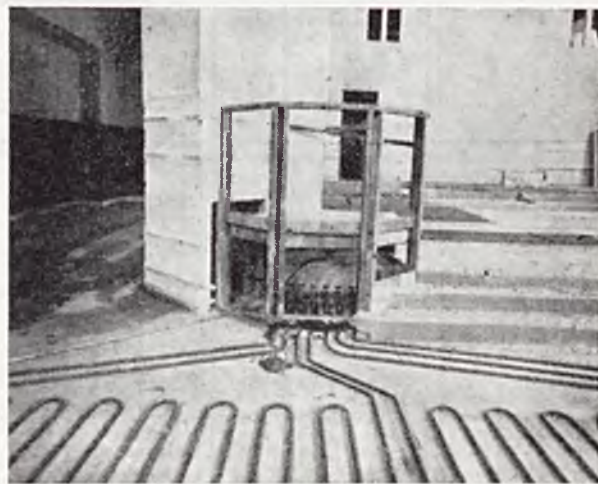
Widok całości instalacji. W głębi na prawo — pokrywanie rur betonem; beton powinien być — o ile można — jak najmniej wilgotny.
